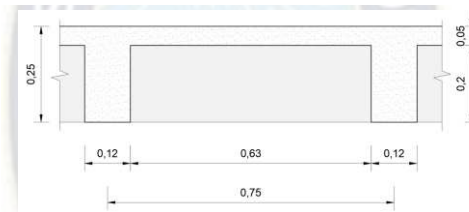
Dimensiones Losa post-tesado aligerada - Fuente: Elaboración propia
